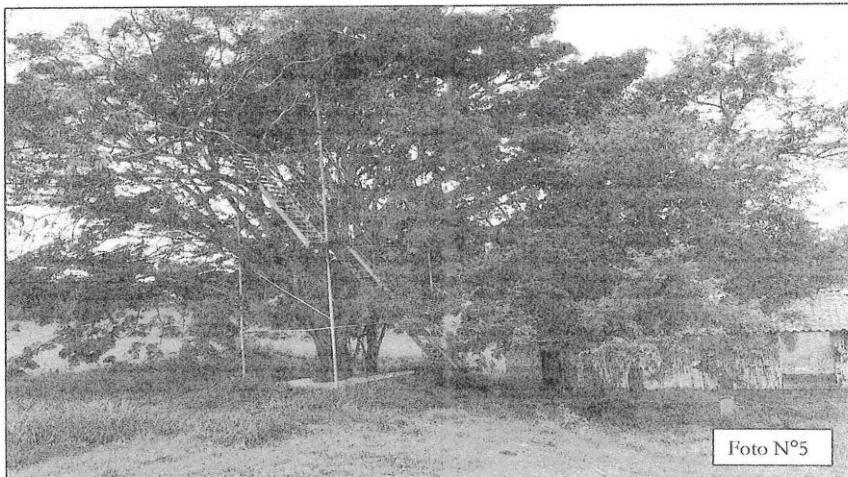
Se observan las estructuras que se mantienen dentro del terreno a desarrollar.
